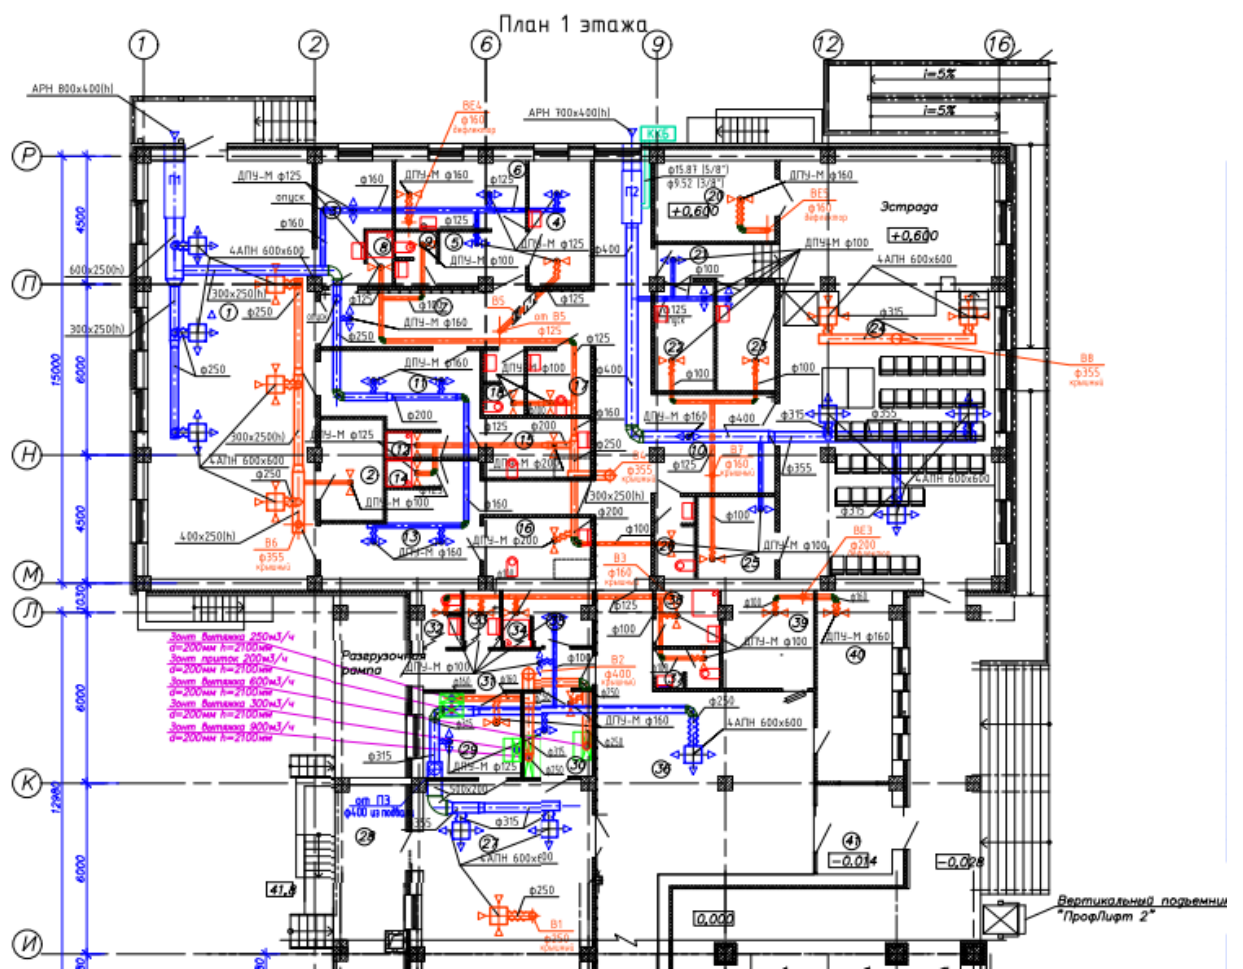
План вентиляции 1 этажа Блоков №2,3
